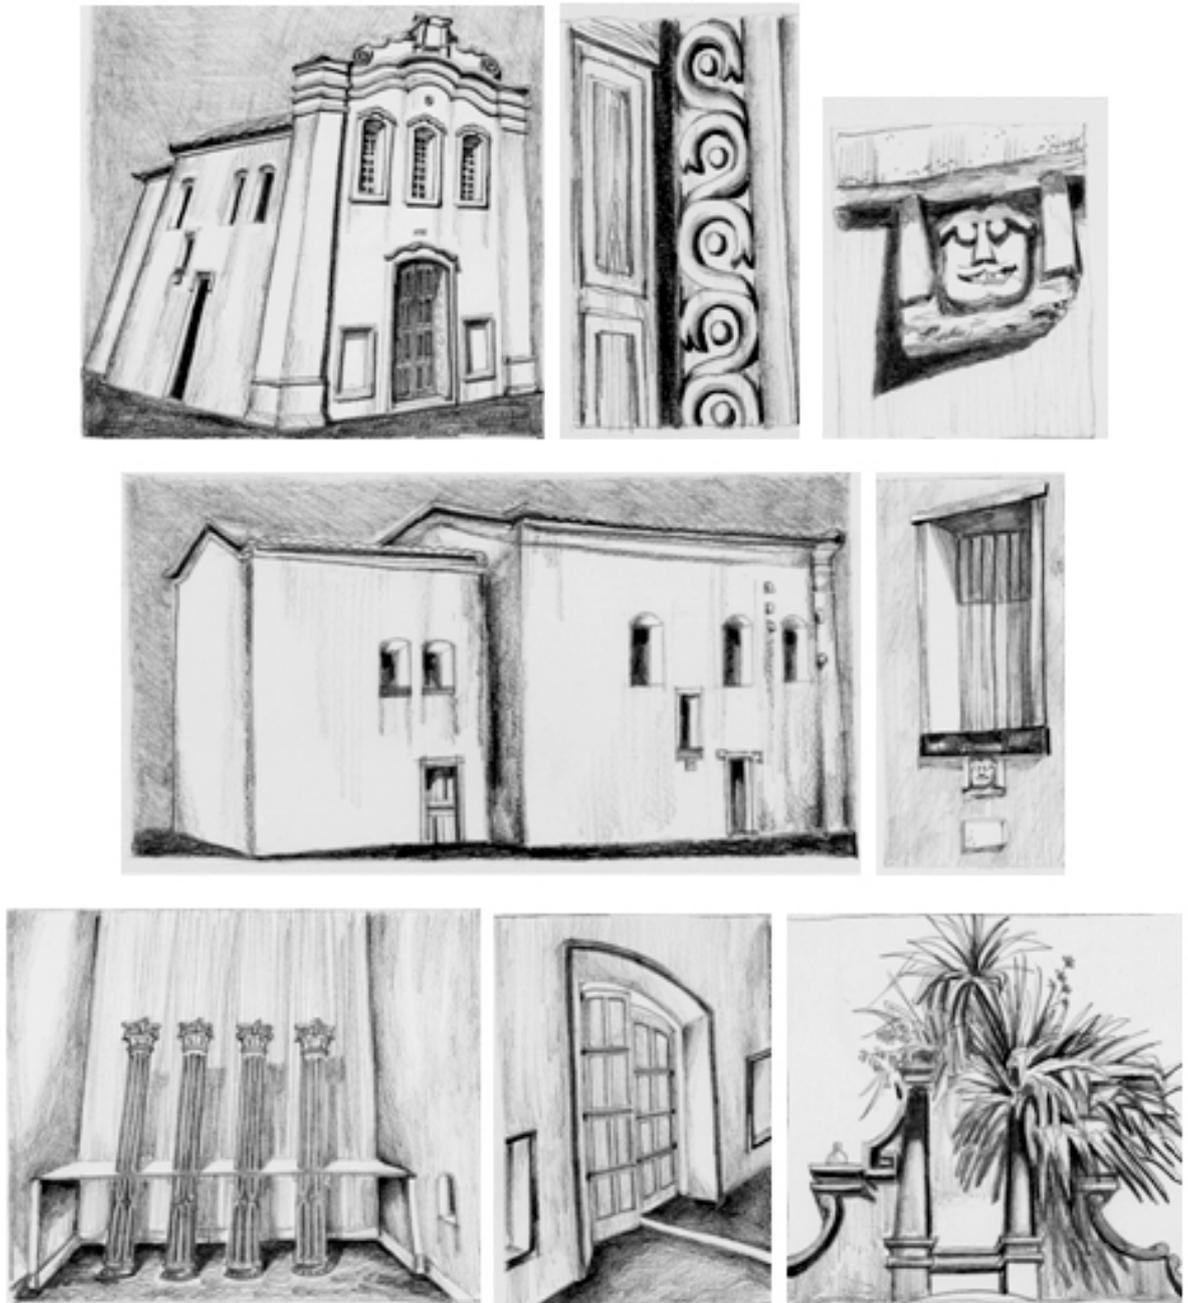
(Acima) – Fachada principal. Centro: Detalhe da portada. Direita: Carranca fachada nordeste. (Centro) – Esquerda: Fachada nordeste. Direita: Porta do pulpito (externa) fachada nordeste. (Abaixo) – Esquerda Altar mor. Centro: Porta entrada lado interno: Direita: Ataque por vegetação no frontão. Estudos: Eder Donizeti; Desenhos: Adriana Nogueira, ago. 2016.
